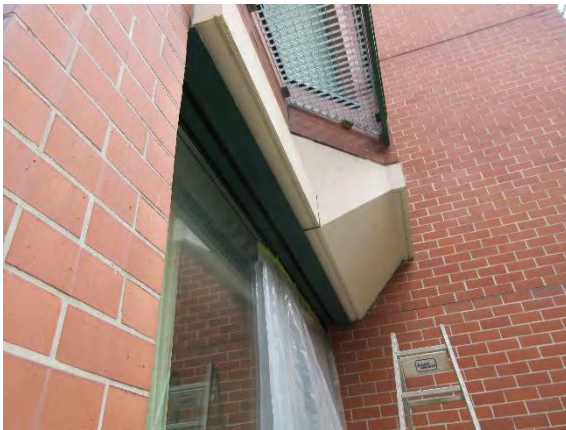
Betonelement K2 (links), K4 (rechts)
